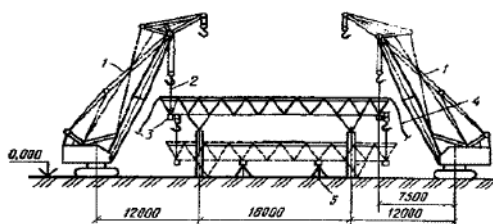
Схема монтажу блоку покриття типу "Кисловодськ" двома кранами: 1 - монтажний кран, 2 - строп, 3 - траверса, 4 - відтяжка, 5 - тимчасова
